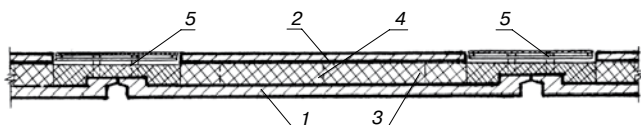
Продольное сечение участка наружной стены из комбинированных наружных стеновых панелей (внутренние стеновые панели условно не показаны): 1 – внутренний несущий слой; 2 – наружный несущий слой; 3 – утеплитель; 4 – связи; 5 – конструкция навесного фасада на участках у вертикальных торцов панелей
